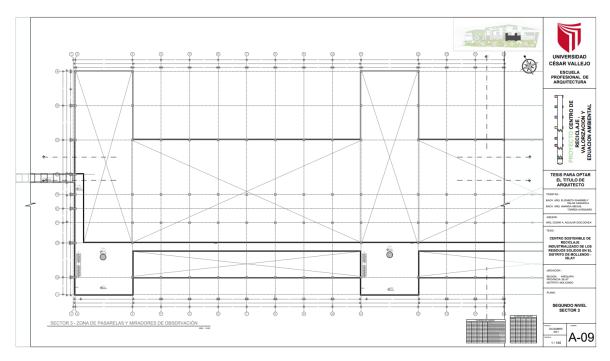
Planta de Distribución, Sector 3 – Segundo Nivel FUENTE: Elaboración Propia
